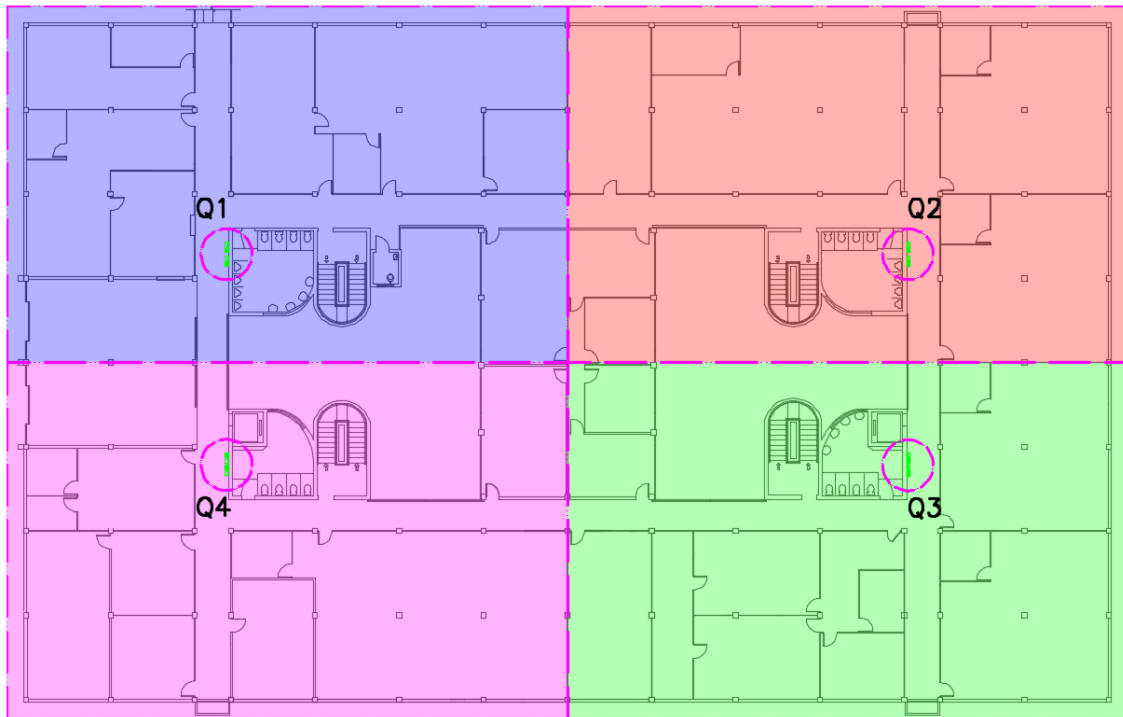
Esquema ilustrando a divisão por quadrantes na planta baixa do primeiro pavimento.
